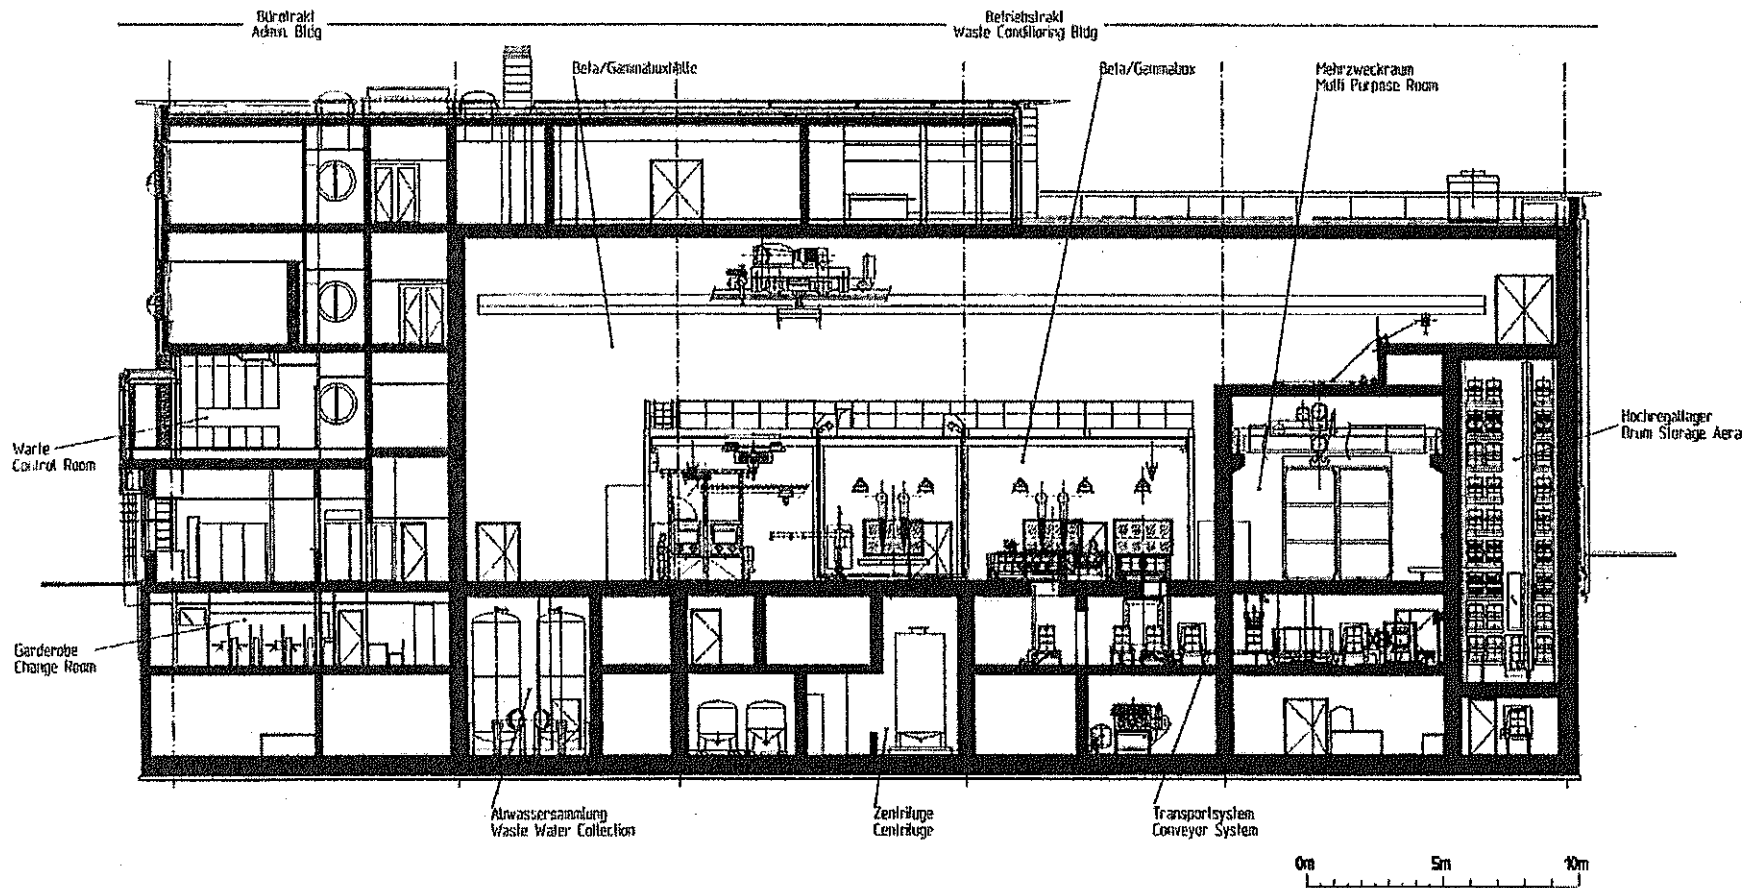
Konditionierungsanlage : Längsschnitt B-B
